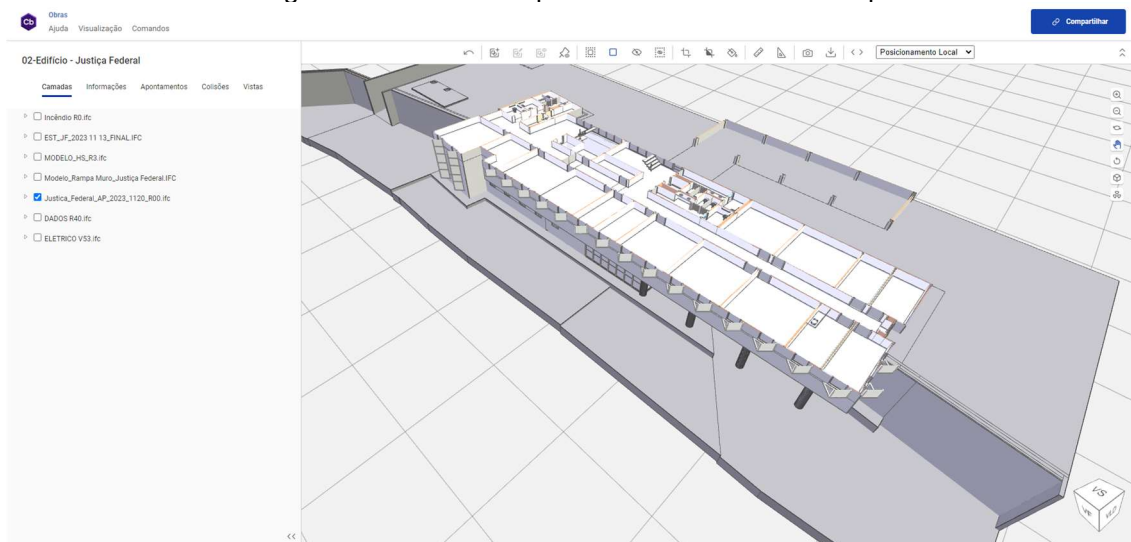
Corte do pavimento térreo do modelo de arquitetura
